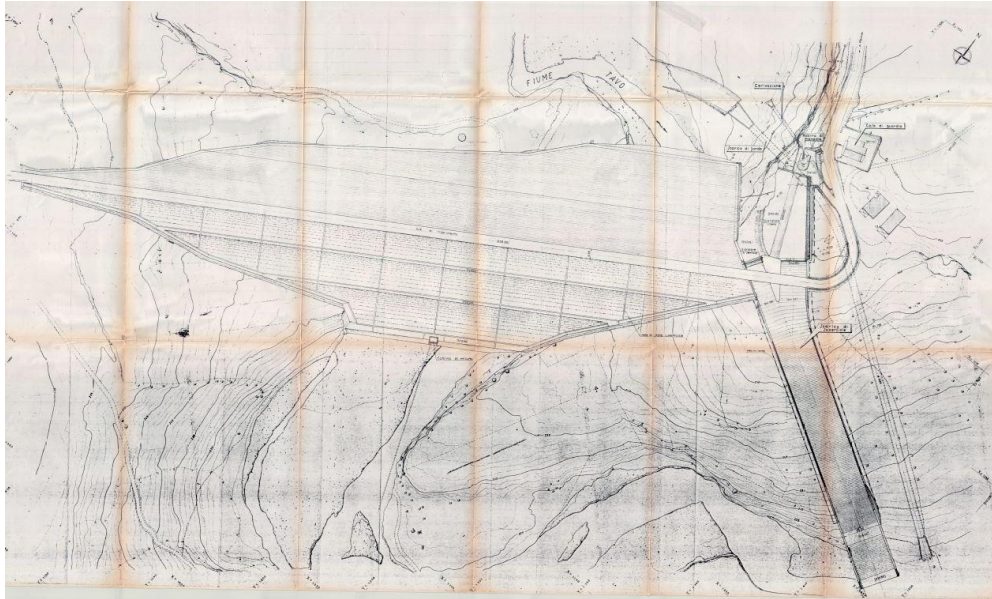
Elaborato V2 – Planimetria, scala 1:500¹⁰
